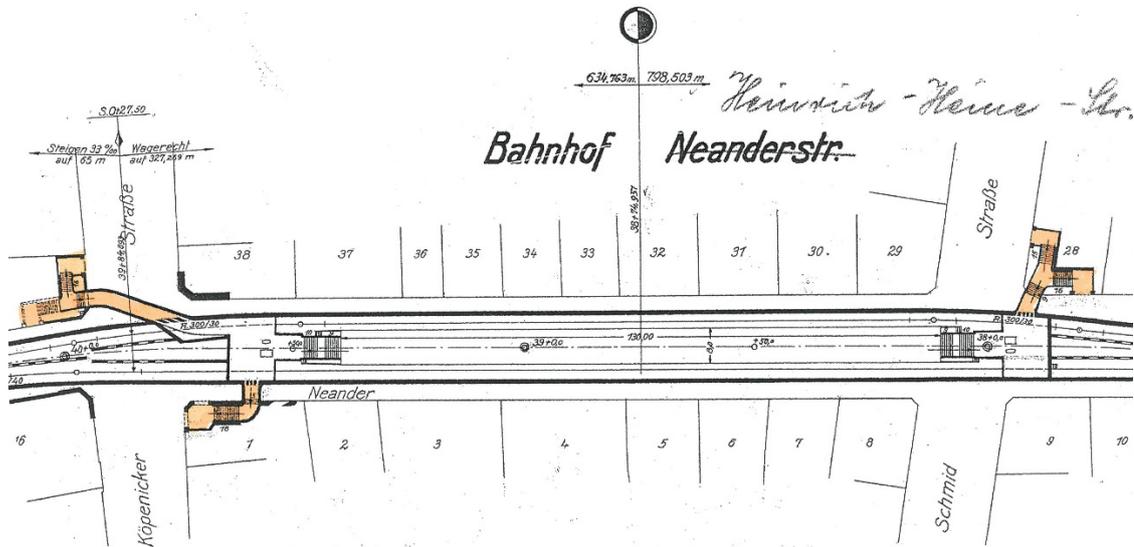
Bahnsteigebene Grundriss aus der Entstehungszeit
